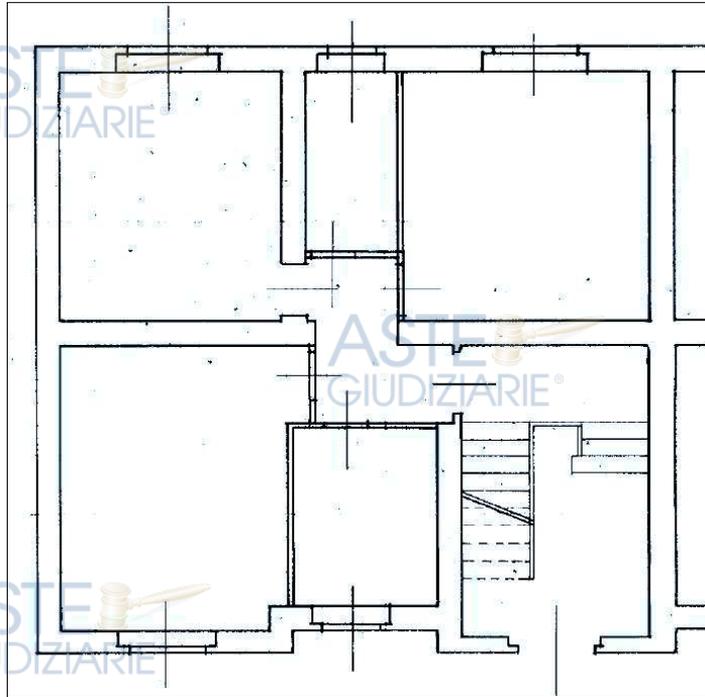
Estratto della planimetria catastale, foglio 6 particella 225 sub 2. Piano rialzato.
